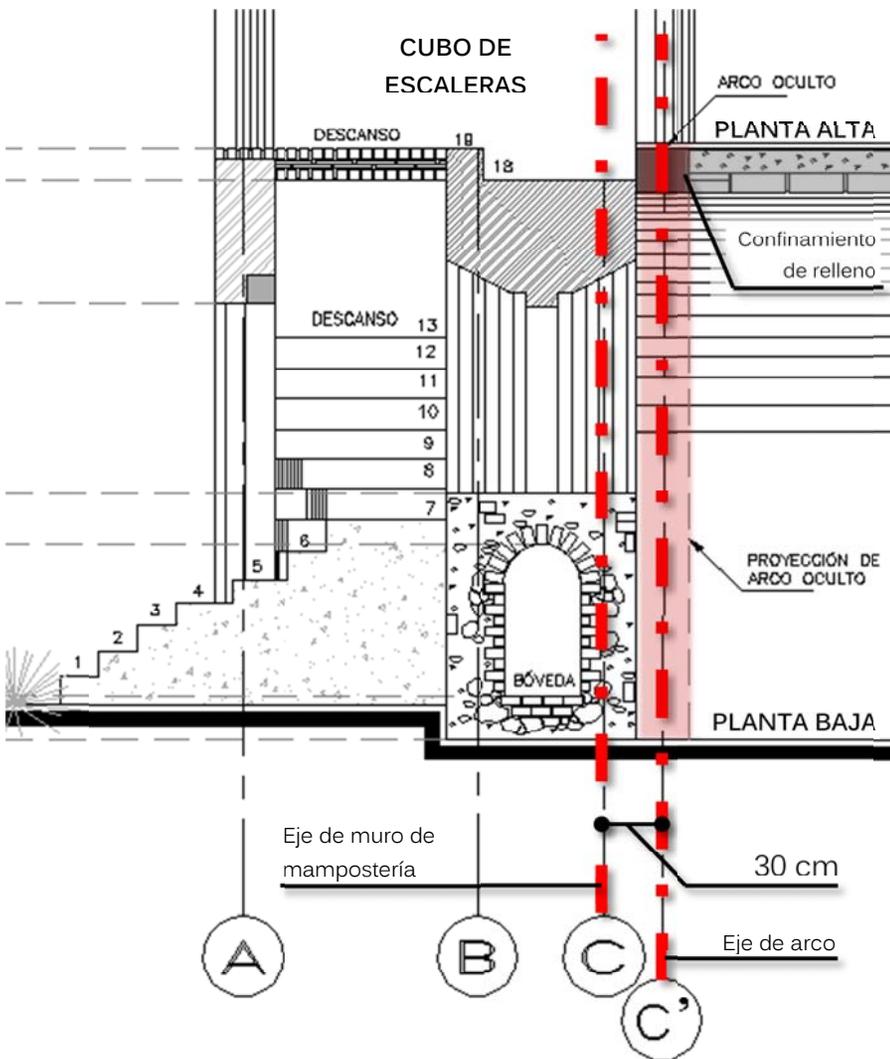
Detalle de posible arco oculto ubicado en la planta baja de la Casa del Administrador.
